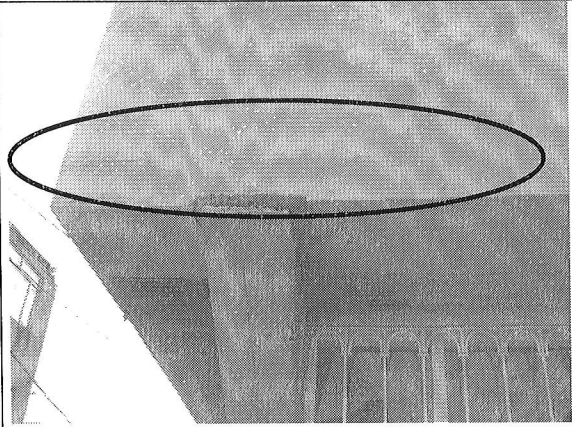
Fisuras que marcan la junta muro-placa.
